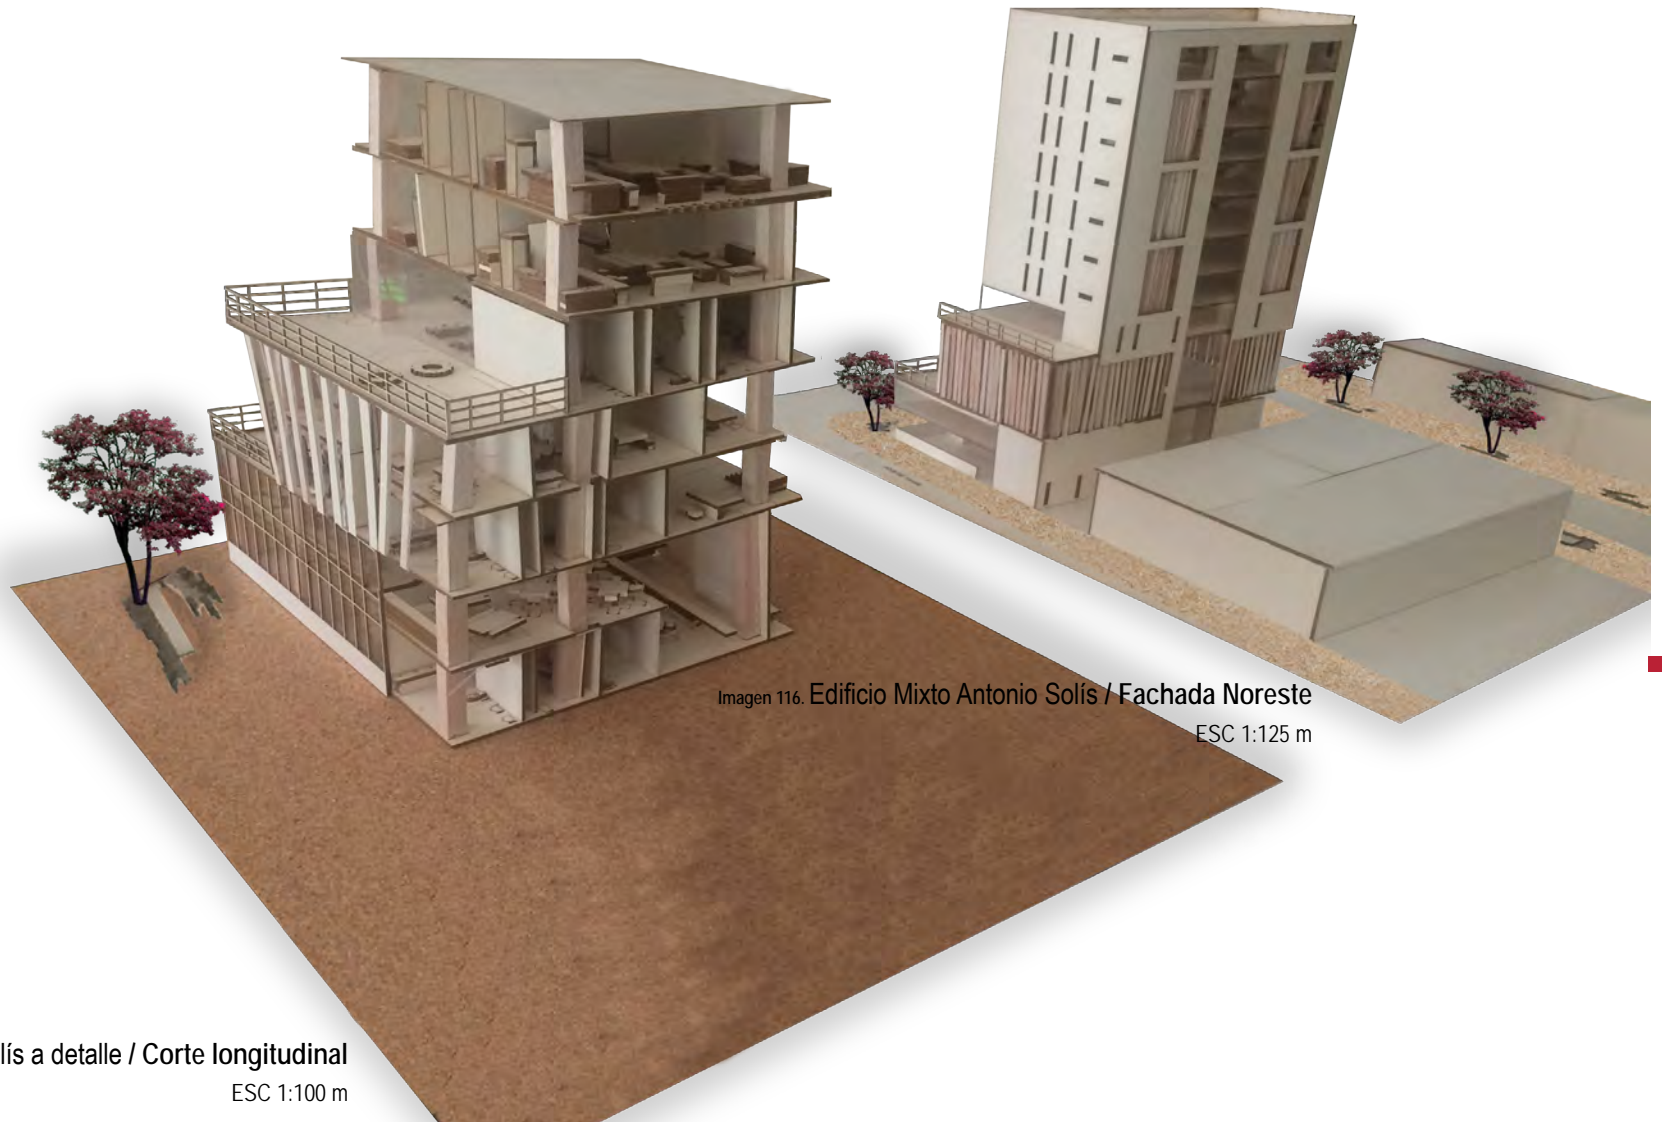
Edificio Mixto Antonio Solís a detalle / Corte longitudinal
